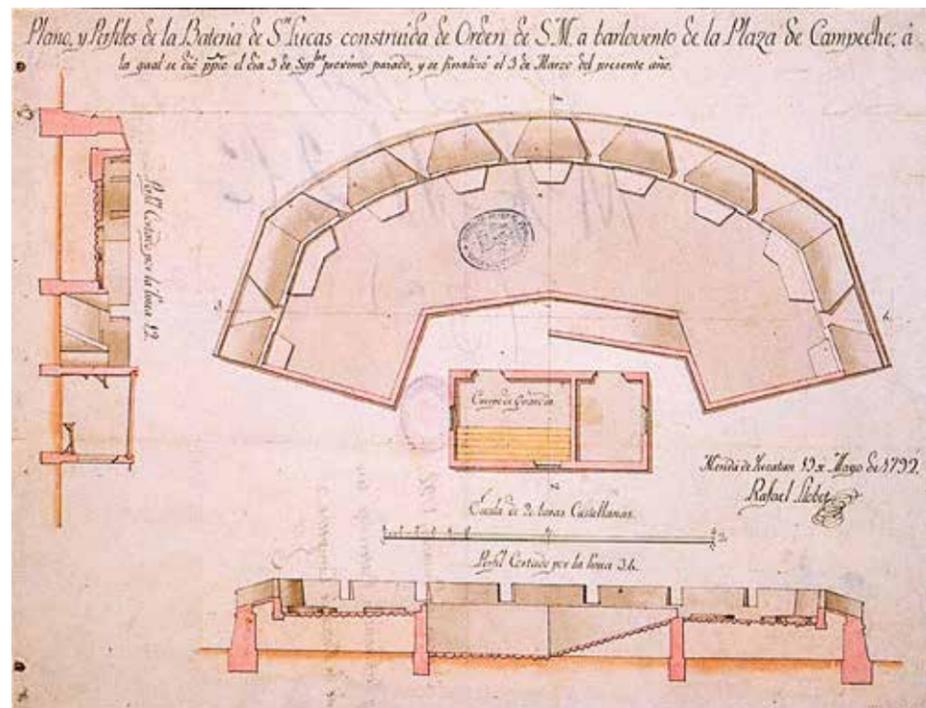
Plano de la Batería de San Lucas por Rafael Llobet, 1792.
